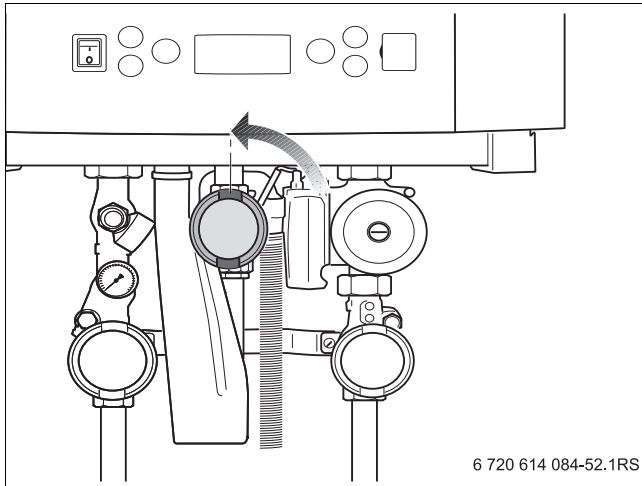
Gashahn öffnen (hier mit Anschlussgruppe)
